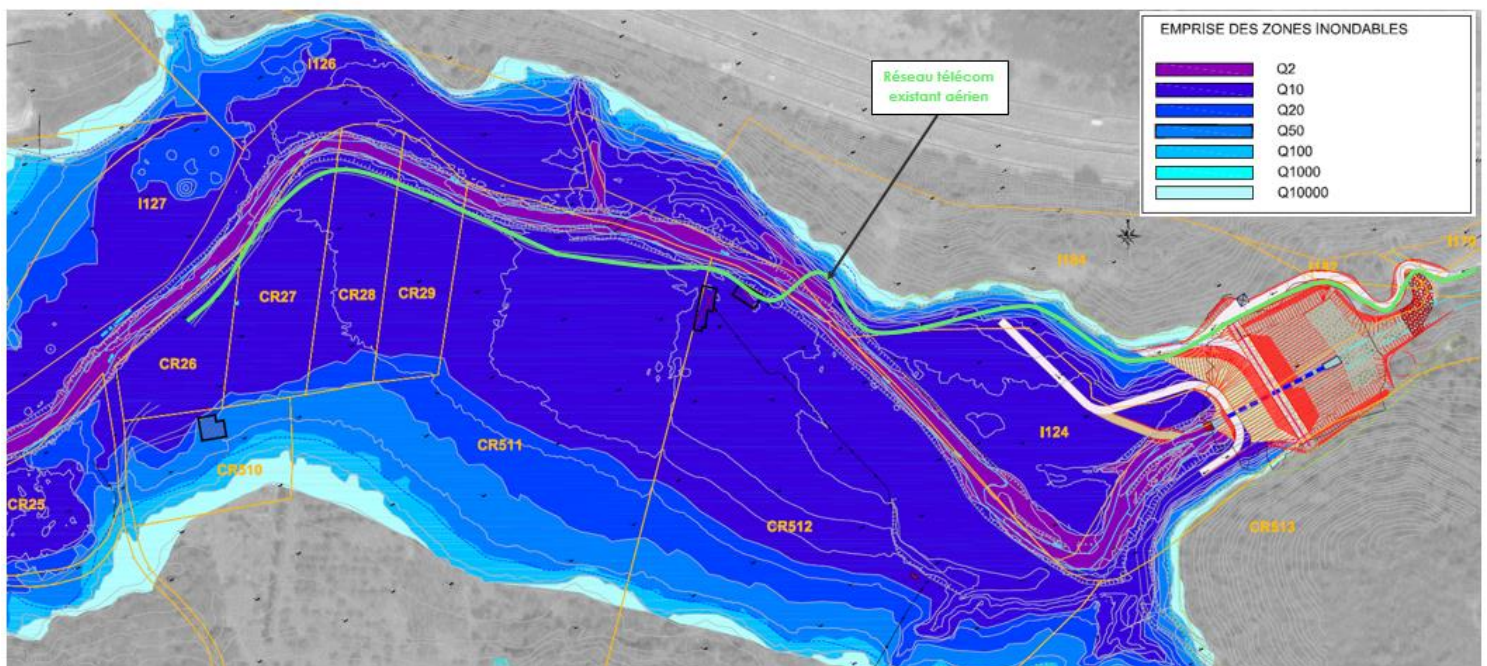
Plan de principe de localisation du réseau télécom aérien existant sur fond de plan d'implantation de la zone d'expansion de crue
